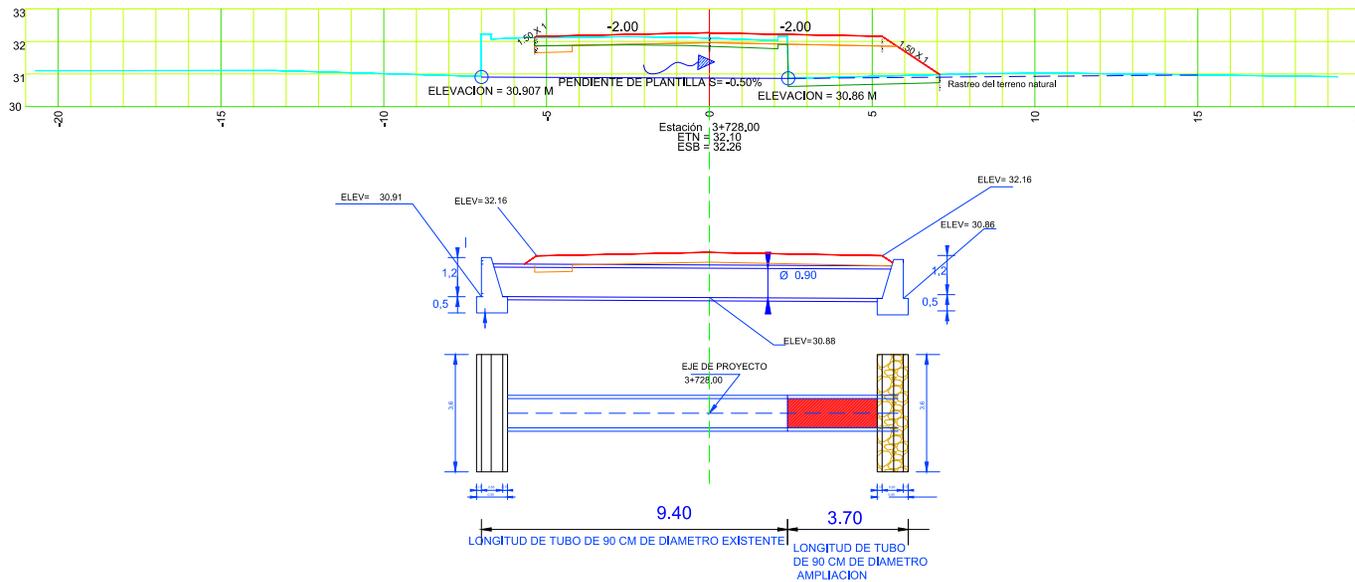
Sección en planta para la colocación de un (1) tubo de concreto
